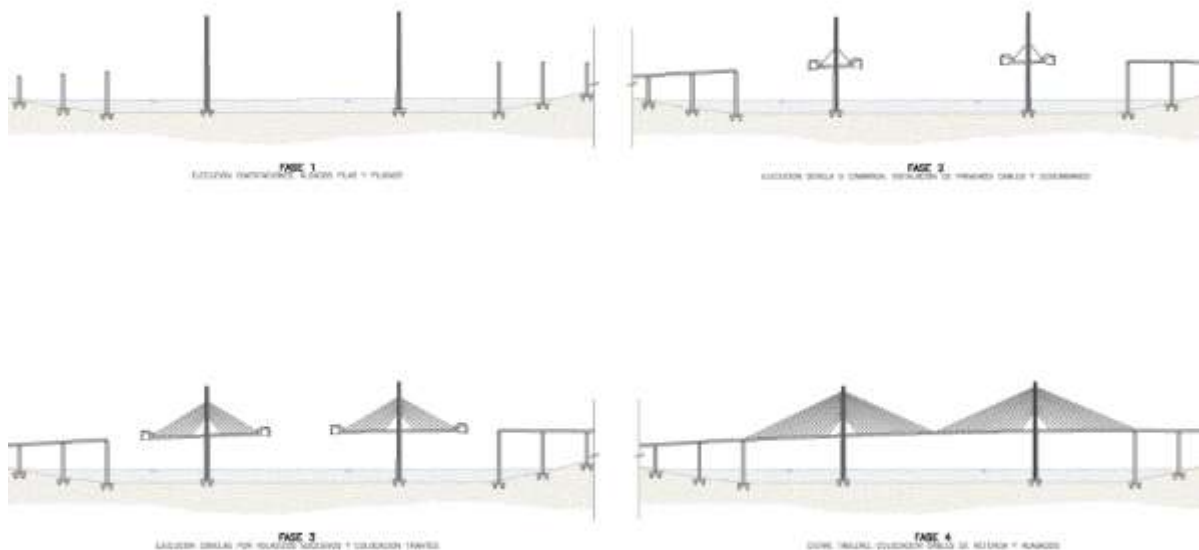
Esquema de las principales fases del proceso constructivo.
